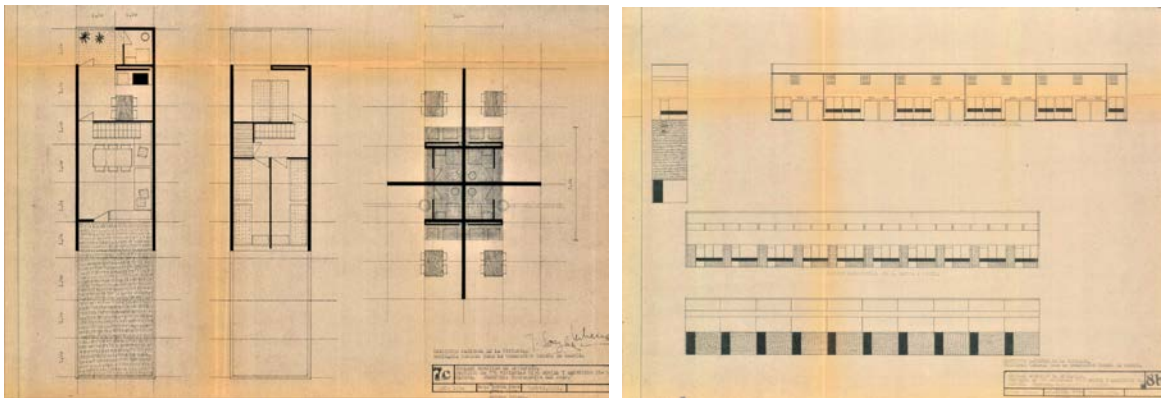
(izda.). Entrevías, Primera Fase, Plano 7c, Vivienda Tipo C, Plantas distribución, Madrid 1956 (idéntico a Vivienda Tipo B).
